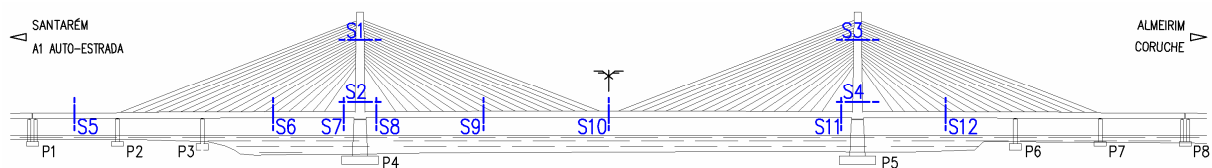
Localização das secções de betão instrumentadas com extensómetros e termómetros
